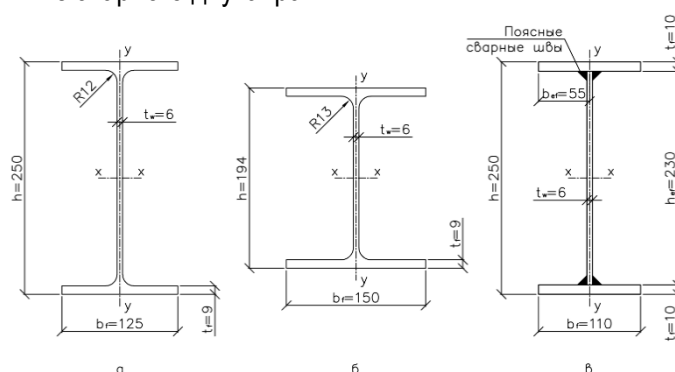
Сечения балок: а – двутавр 25Б2; б – двутавр I20Ш1; в – сварная балка
